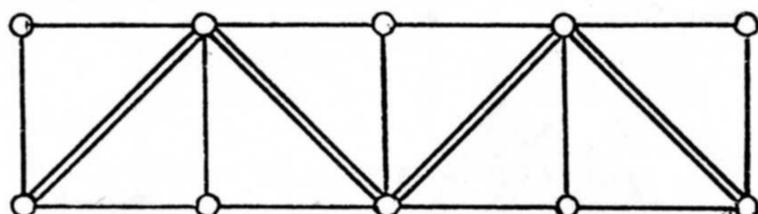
Fachwerk aus gleichschenkeligen Dreiecken.
